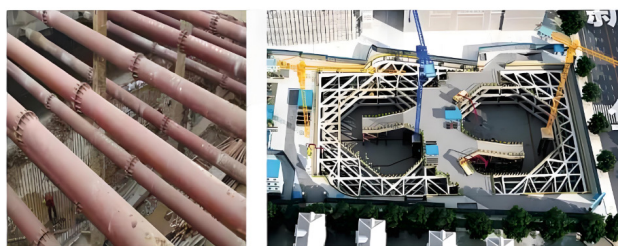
钢支撑（左）、钢筋混凝土支撑（右）示意图
